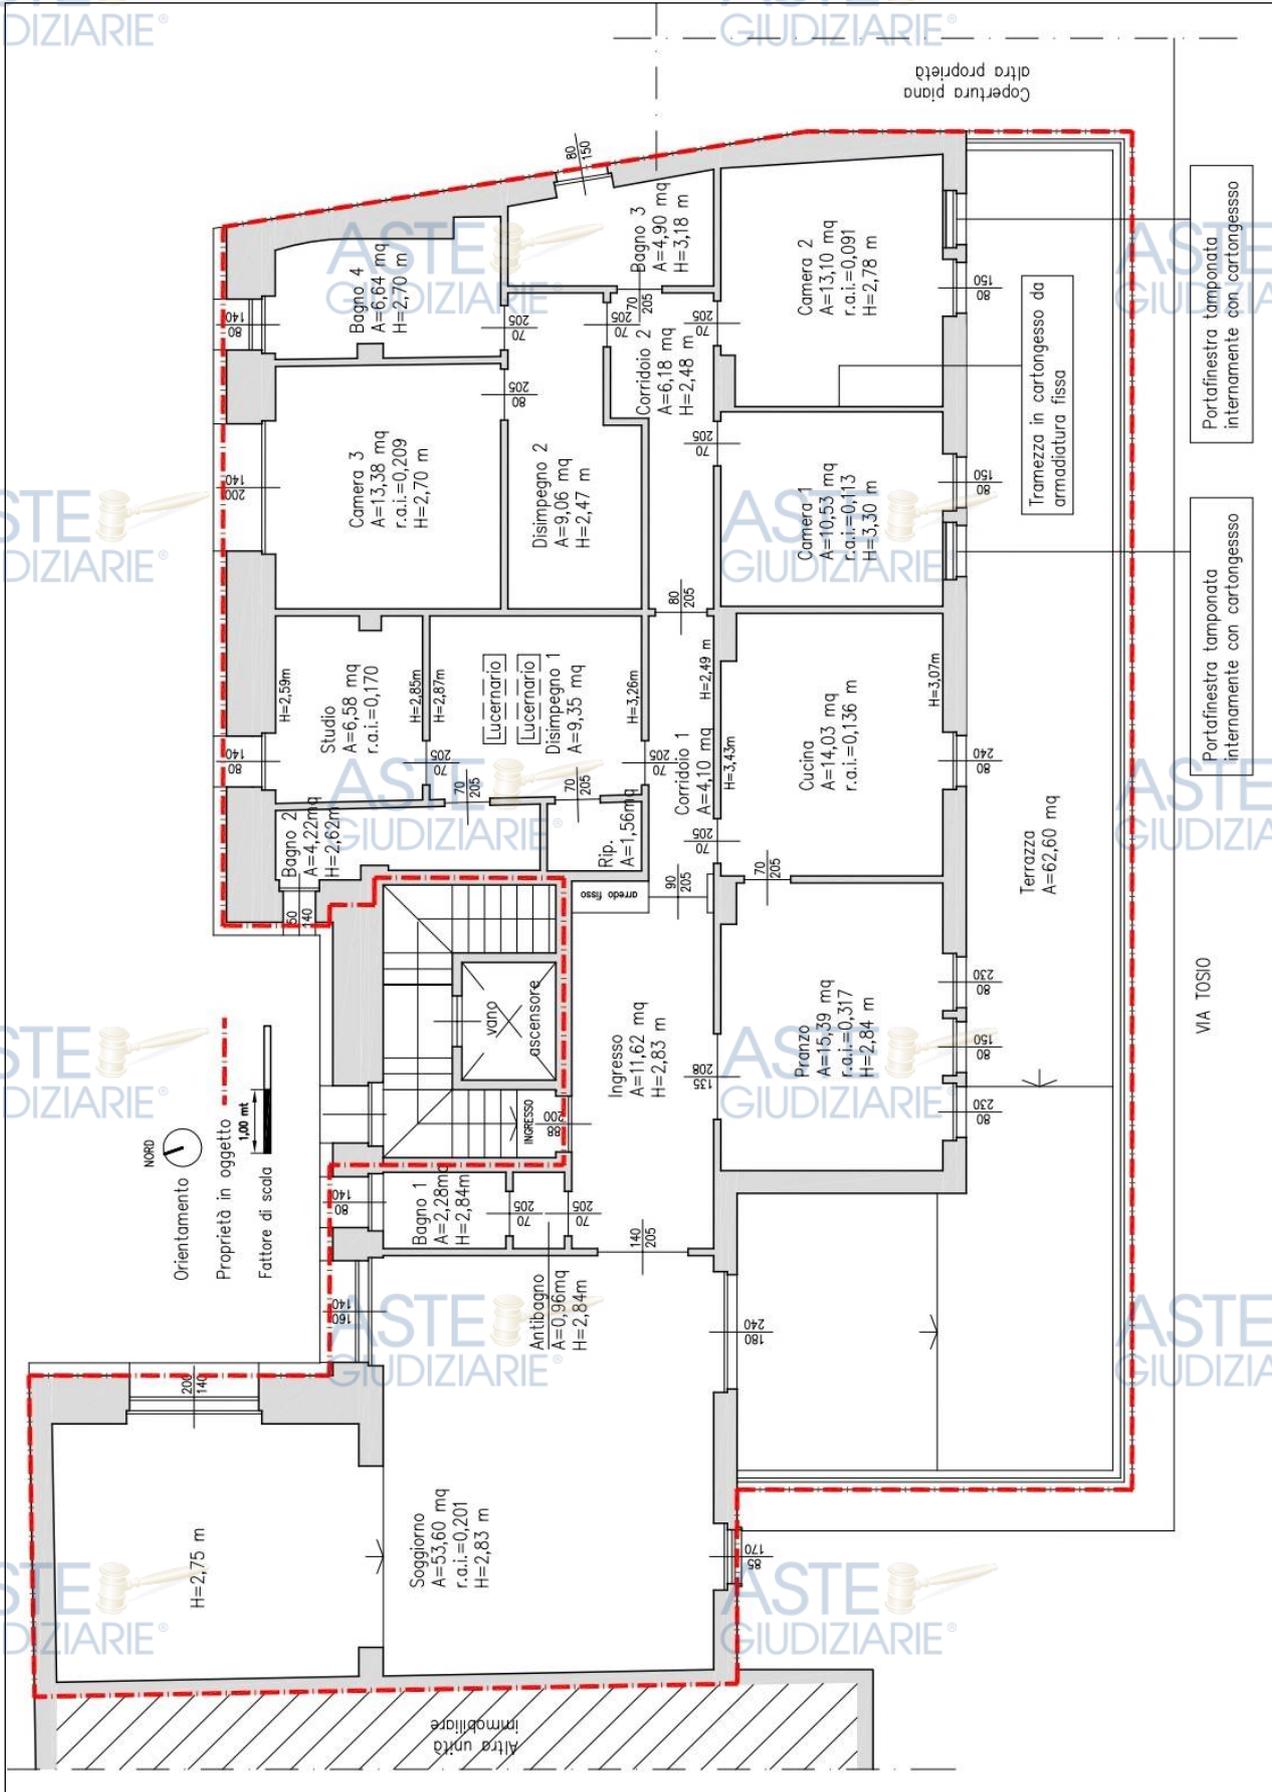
Piano quinto - Pianta abitazione -Part. 316 sub. 24
